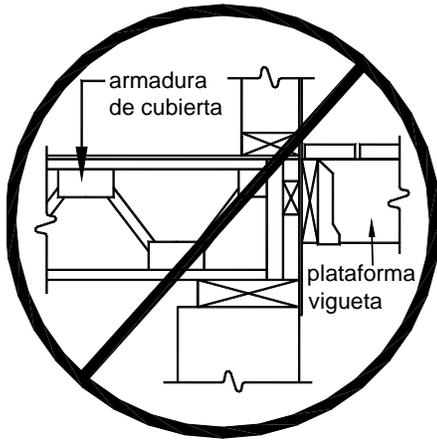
SIN UNIÓN CON LA ARMADURA DE CUBIERTA
